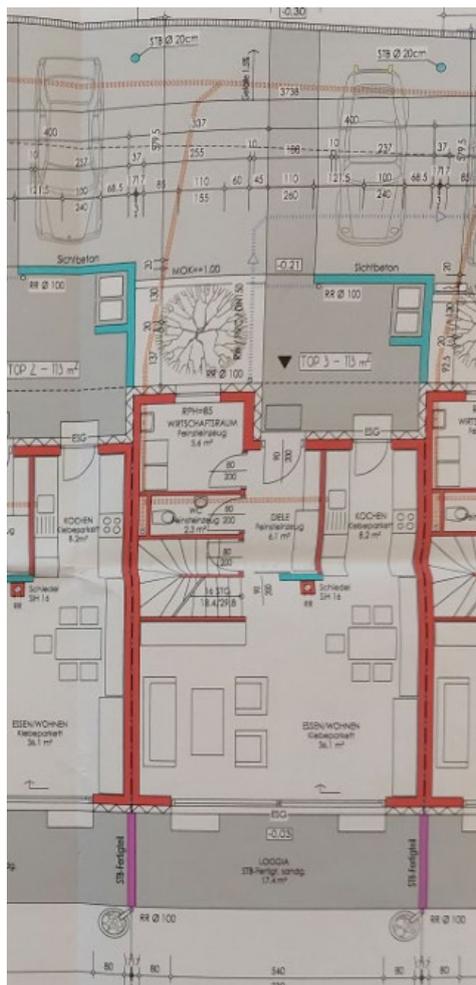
Top 3 - Grundriss EG | Einreichplan | 26.08.2014
